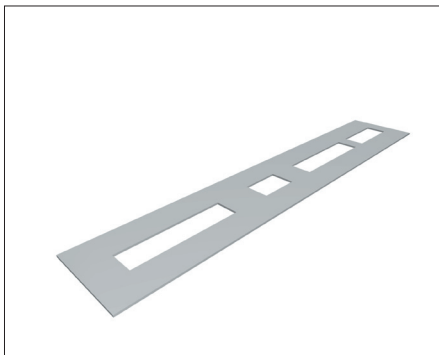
Konstruktion: Der Deckenschott steht im Zusammenhang mit dem Boden-Decken-Element. Er beinhaltet selbst keine konstruktiven Bauteile. Die Lastabtragung des darüber montierten vertikalen Schachtes übernimmt die Boden-Decken-Konstruktion. Zur Sicherung der Brandschutzsysteme und -formsteine gegen „Nach-unten-fallen“ wird eine Brandschutzplatte unterseitig montiert.
